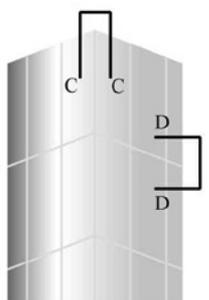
A: Vista verticale. Esempio di vetrata strutturale: a due lati (installazione in cantiere).
